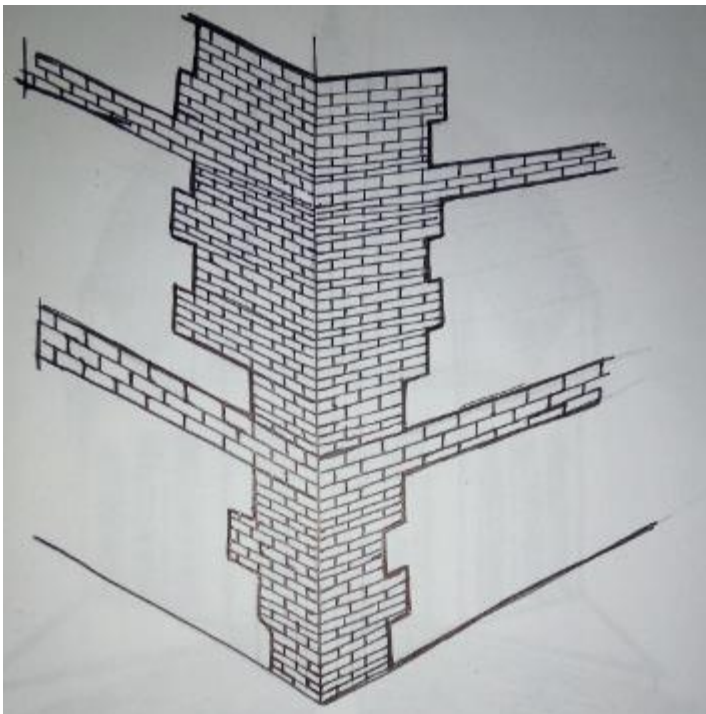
Muro de mampostería con verdugadas de ladrillo. Fuentes propias
